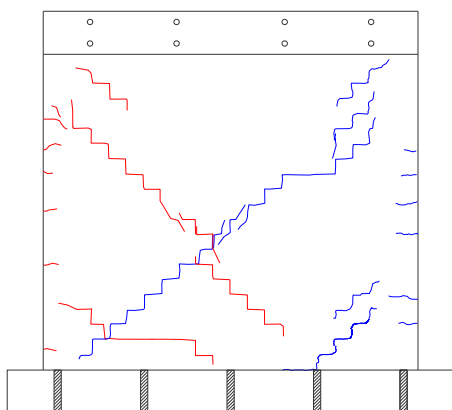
Reparación Tipo II en muro de albañilería confinada con ladrillos pandereta industrial en la distorsión 1/2150.
